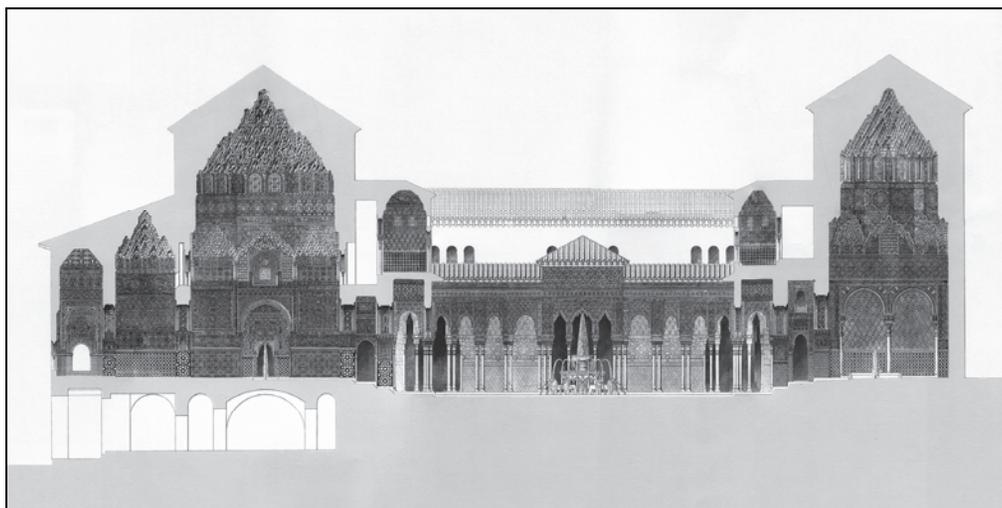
Owen Jones y J. Gourey. Sección transversal del palacio de los Leones, en *Plans, elevations and sections of the Alhambra*, 1842-45.
